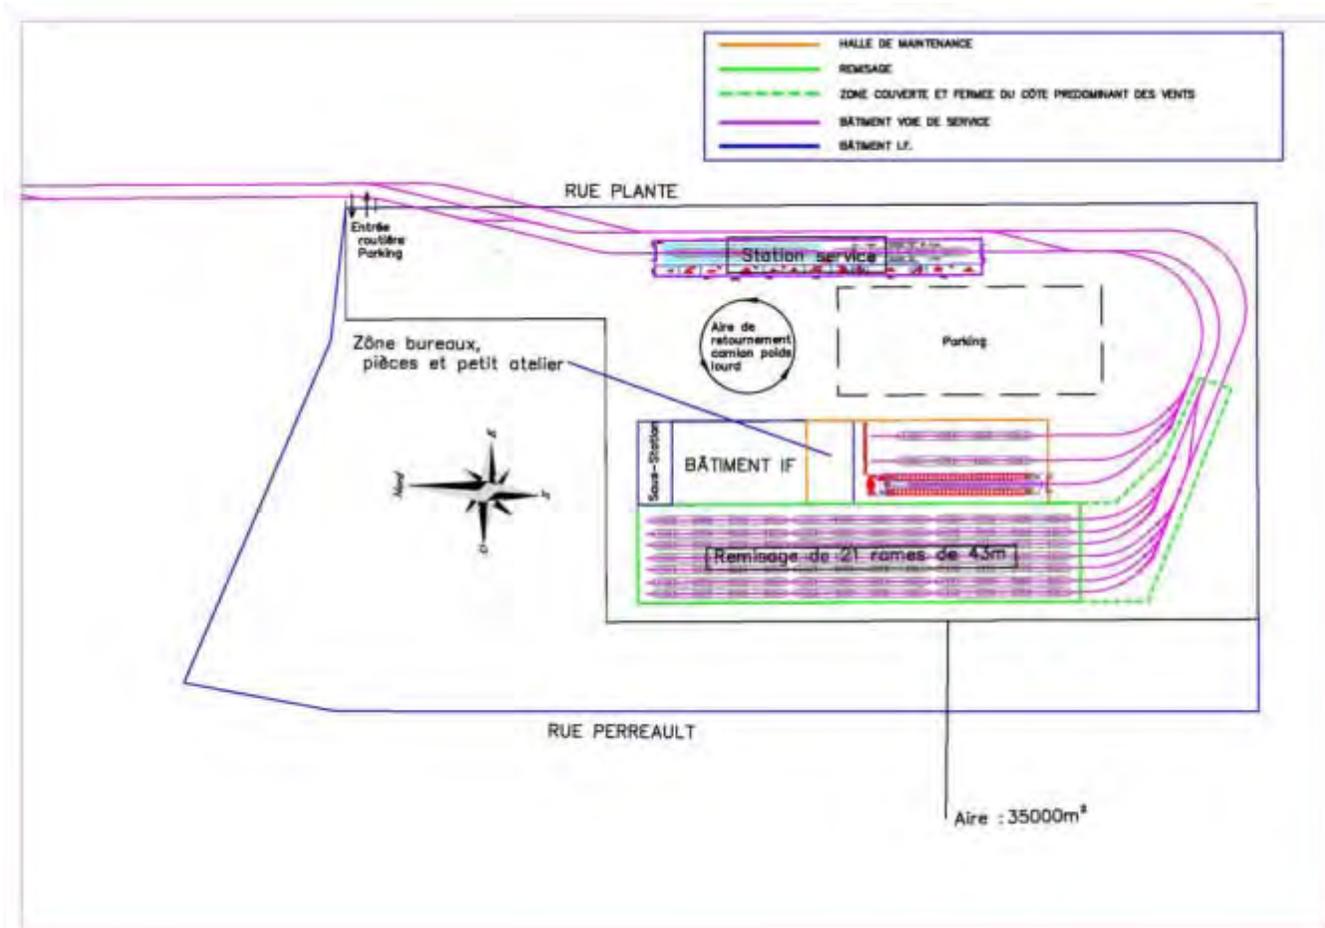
Plan masse du CEE secondaire rue plante à Lévis
